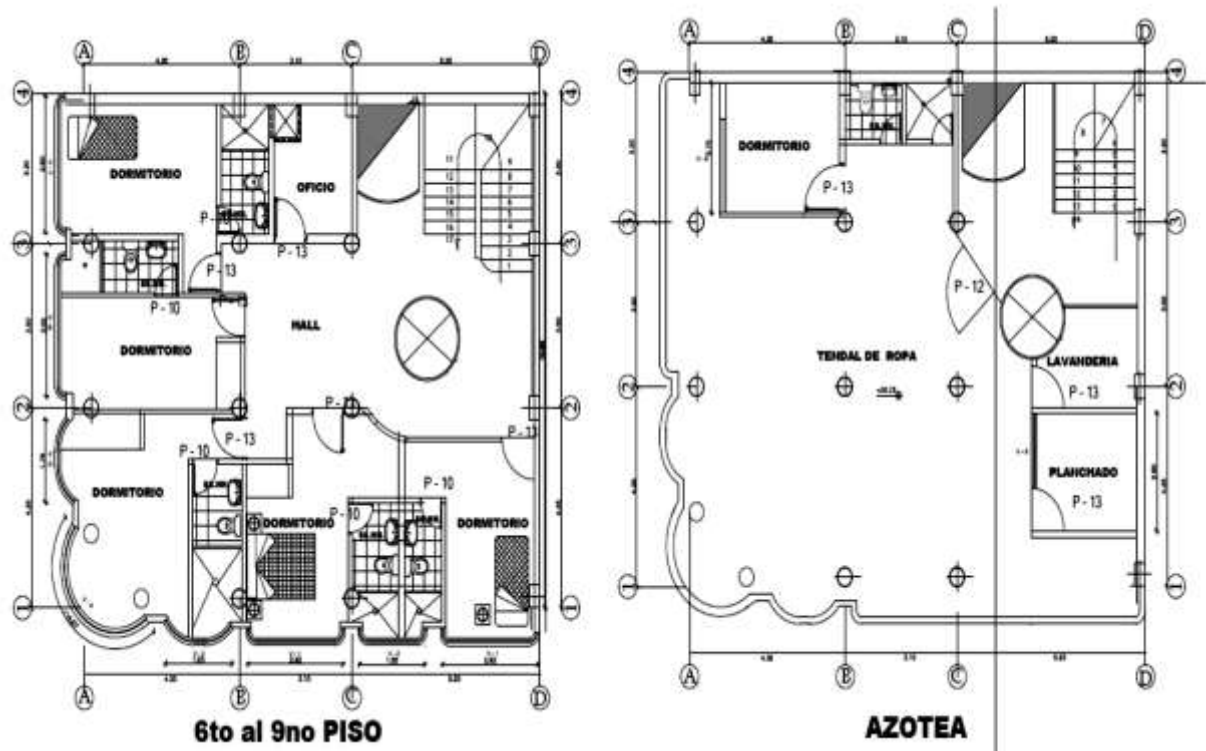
Plano en planta 6to al 9no nivel y azotea del edificio.
